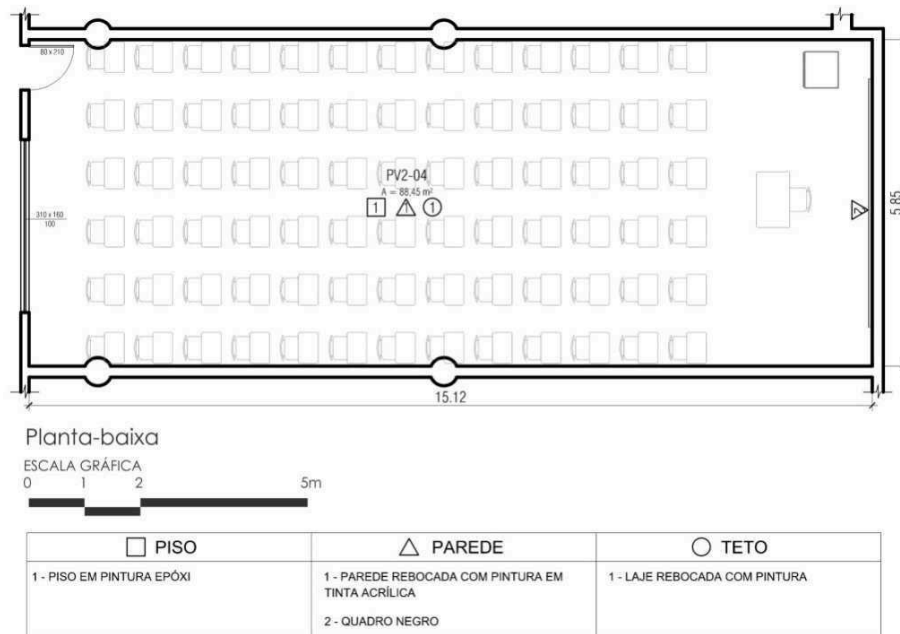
Planta e quadro de acabamentos da Sala PV2-04
